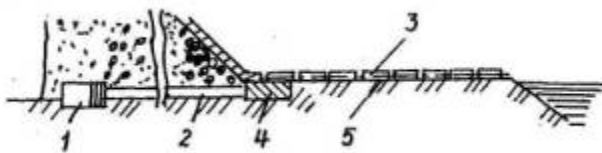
Конструкция тюфяков из железобетонных блоков с минимальными зазорами:
